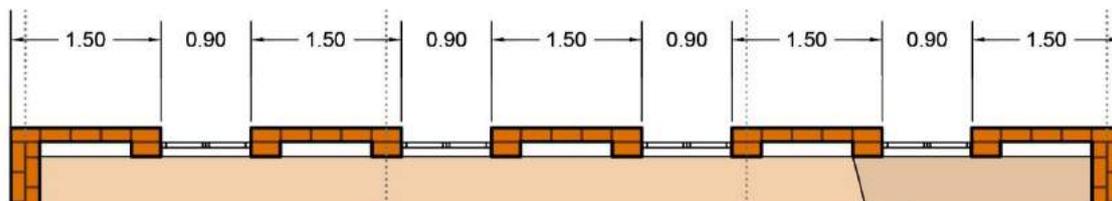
Detalle muro. Fuente: Elaboración propia
